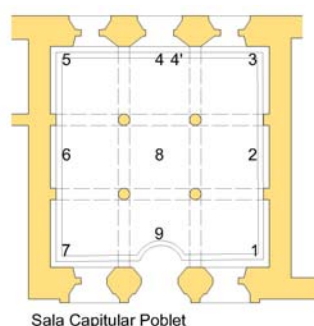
Planta de la sala capitular del monasterio de Santa María de Poblet
